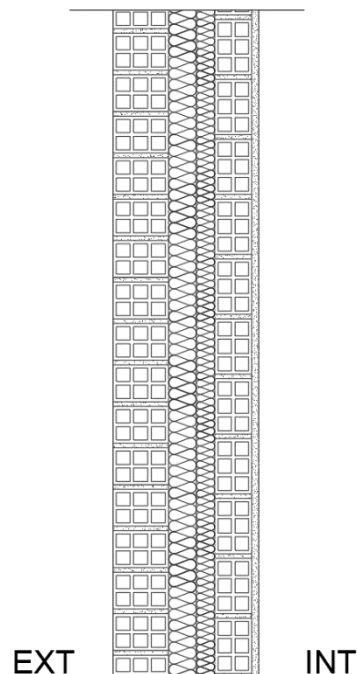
Detalle construtivo do muro medianoiro tras a inxección de cámaras. Elaboración propia.
